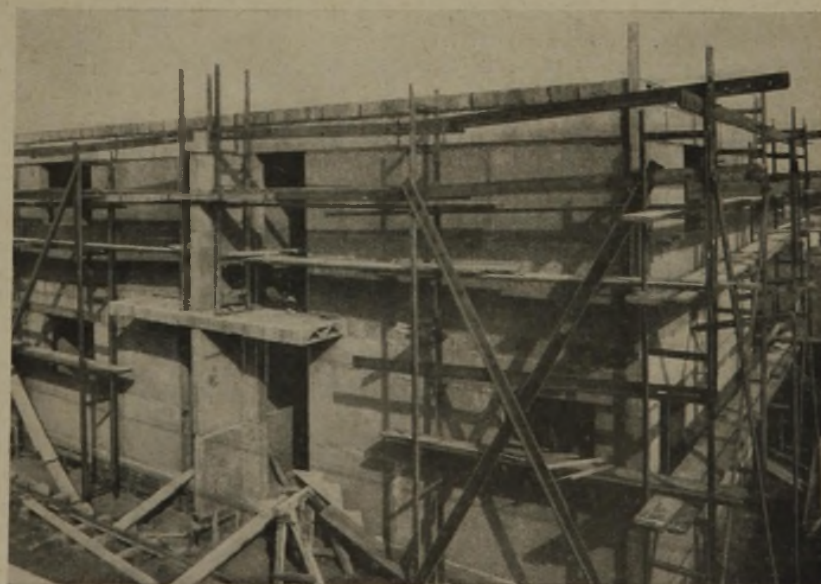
17. Montage der Häuser aus fertigen Platten und Betonbalken. (Phot. H. Collichonn, Frankfurt a. M.)
